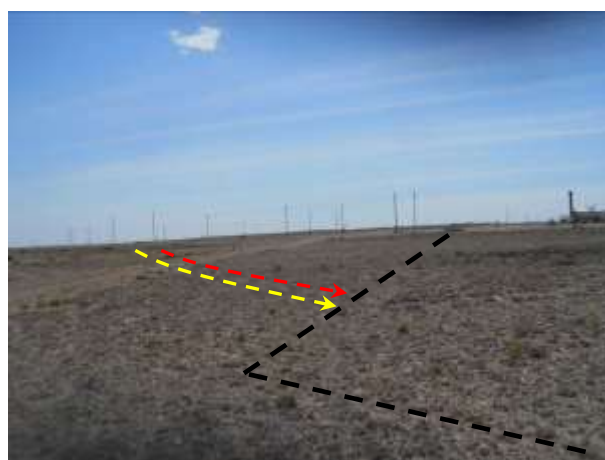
Destino final de los ductos en futura Batería EA-III (negro). Foto en dirección NE.
